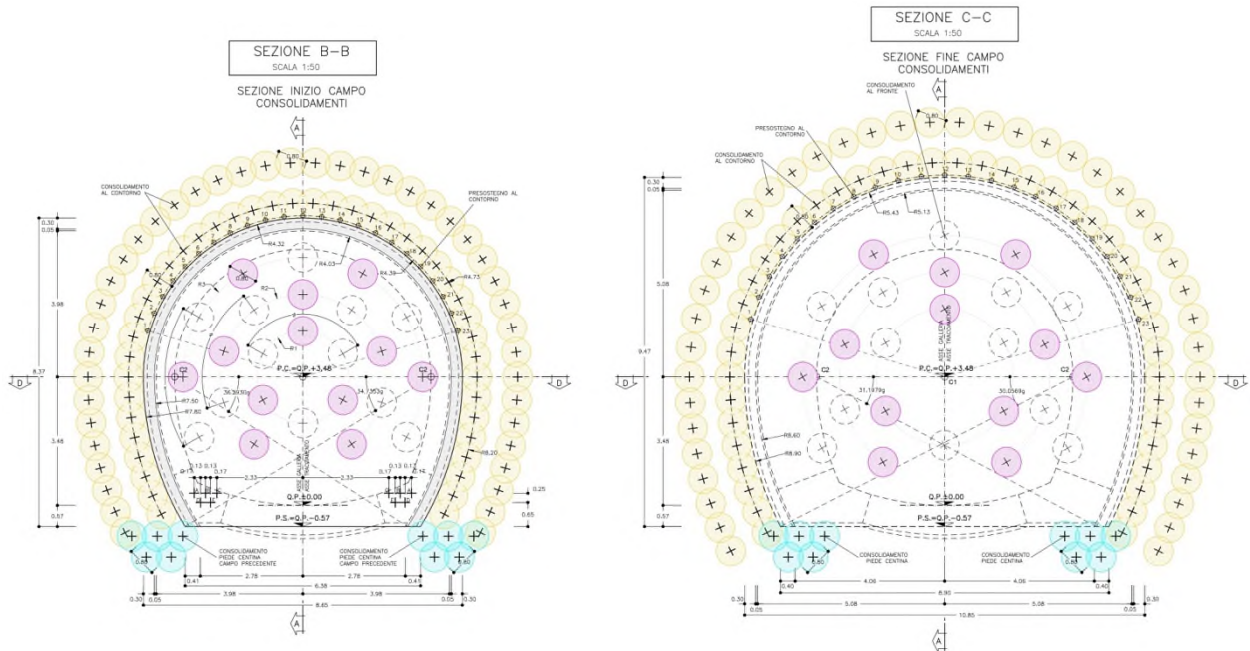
Sezione Tipo C1 – Scavi e consolidamenti - Sezione
